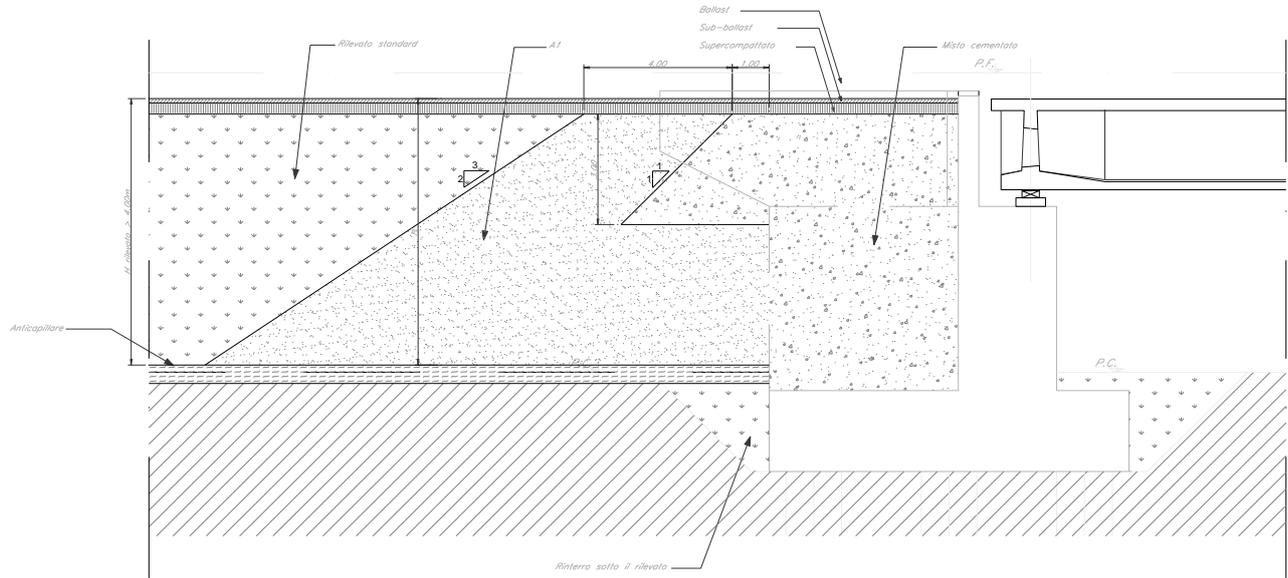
Zona di transizione rilevato – spalla viadotto/ponte con  $H > 4,00$  m
